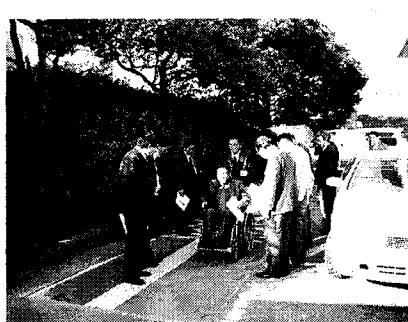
舗装材の試験施工現場での車椅子走行実験の様子
